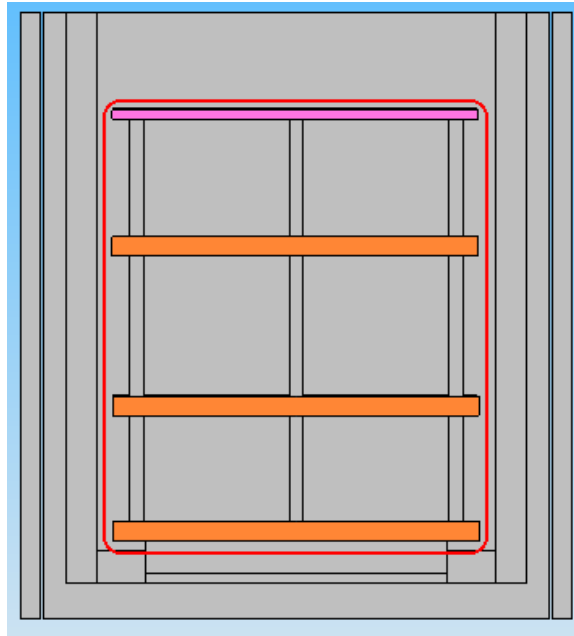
7: Detalle de la posición de las plantas en el cubo
